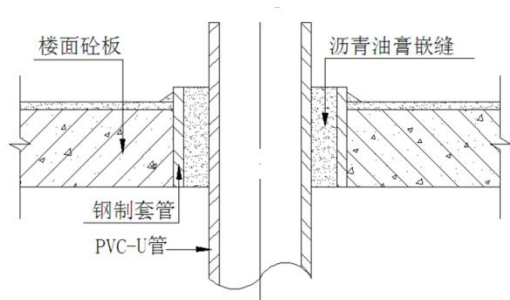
给排水管道和采暖管道系统穿楼板做法示意图（非用水房间）
